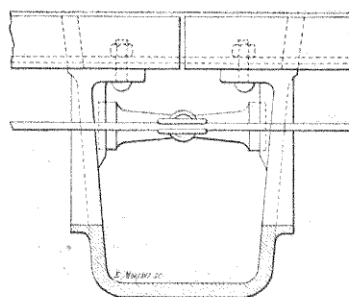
Coupe longitudinale du caniveau actuel de Blackpool.
